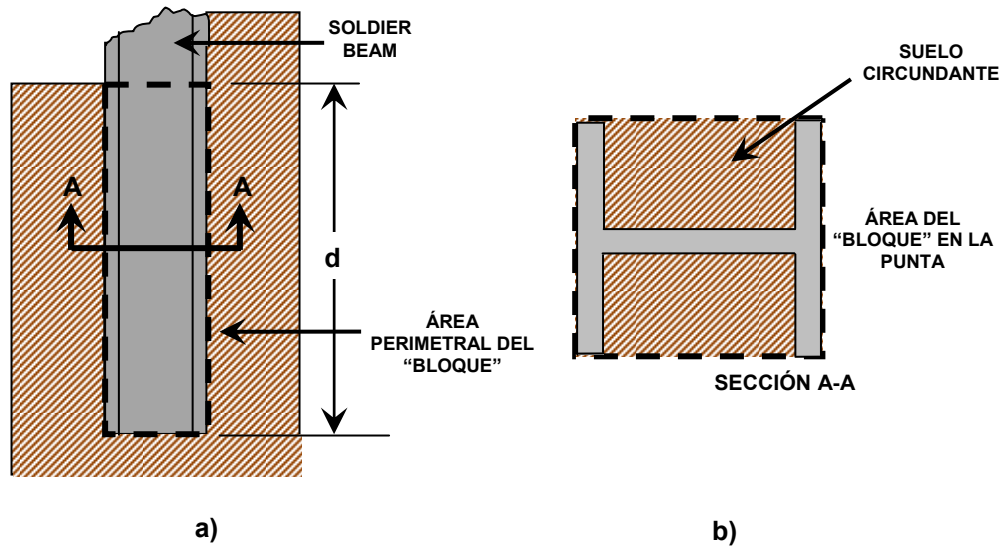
a) Vista del área perimetral. b) Vista de la sección en la punta del soldier beam.
